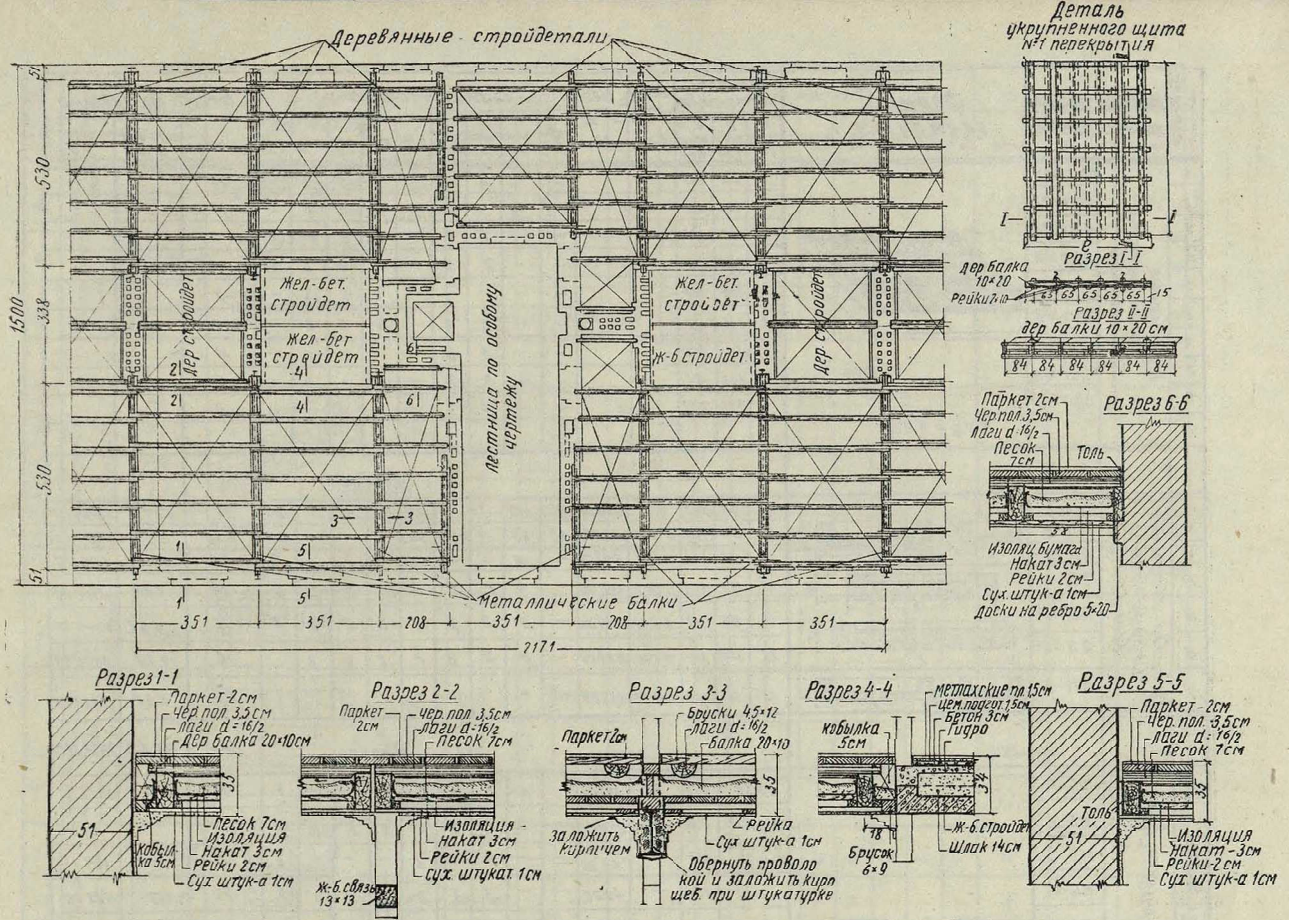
План и разрезы деревянного перекрытия для типовой секции Управления жилищного строительства (см. рис. 1).
